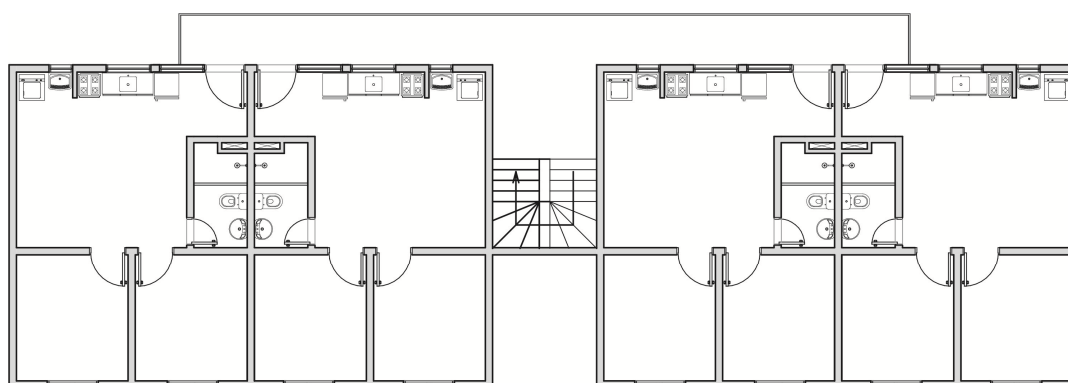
Planta baixa do Projeto-proposto B (escala indeterminada).
